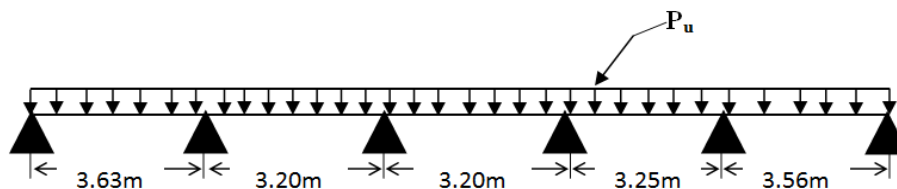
Schéma statique d'une poutrelle d'étage courant type 03
